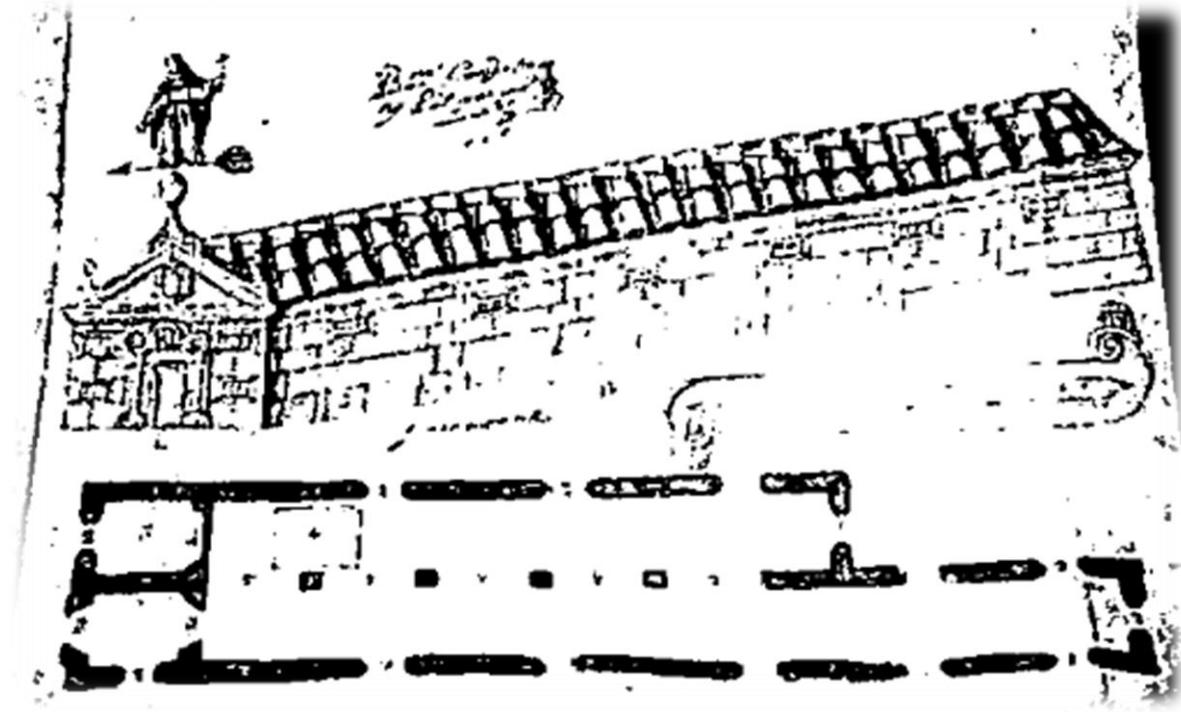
Planta y alzado del antiguo Pósito de Montilla³³
